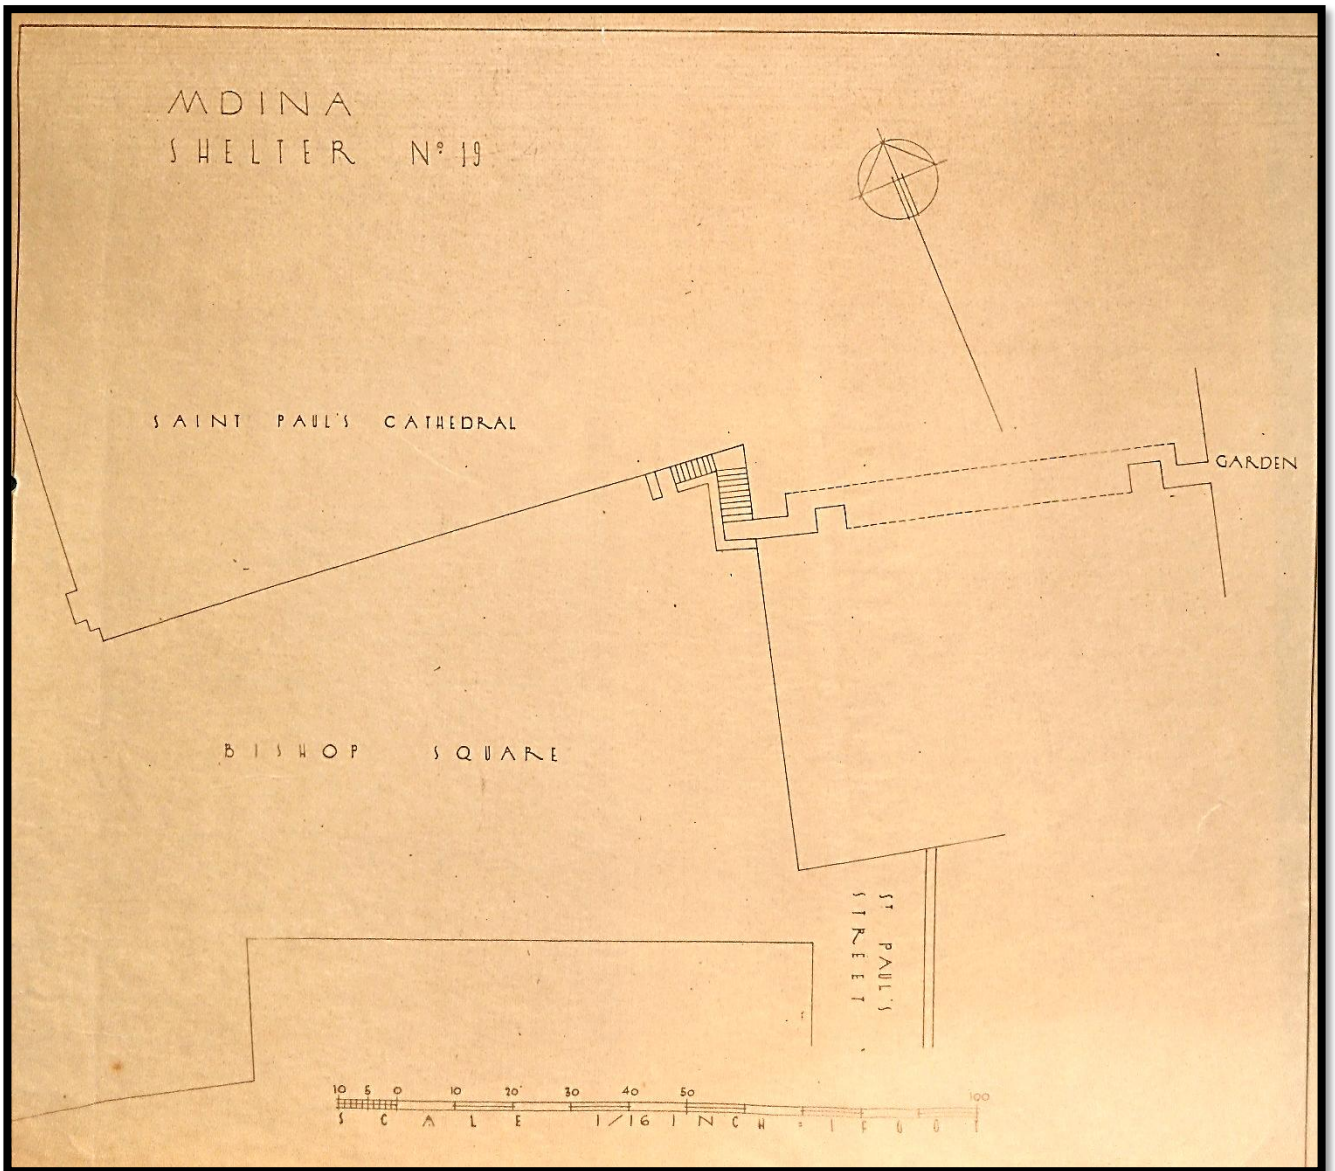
Planta do Abrigo nº19 (4) "Bishop Square – St. Paul's Street."
